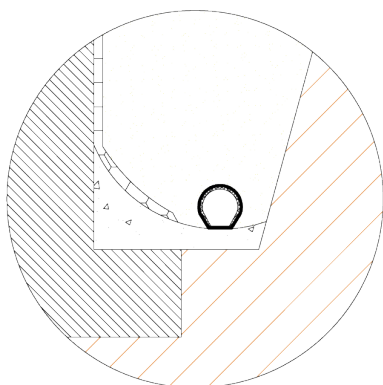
COUPE DE PRINCIPE D'UN ACCOTEMENT & D'UNE CUNETTE
